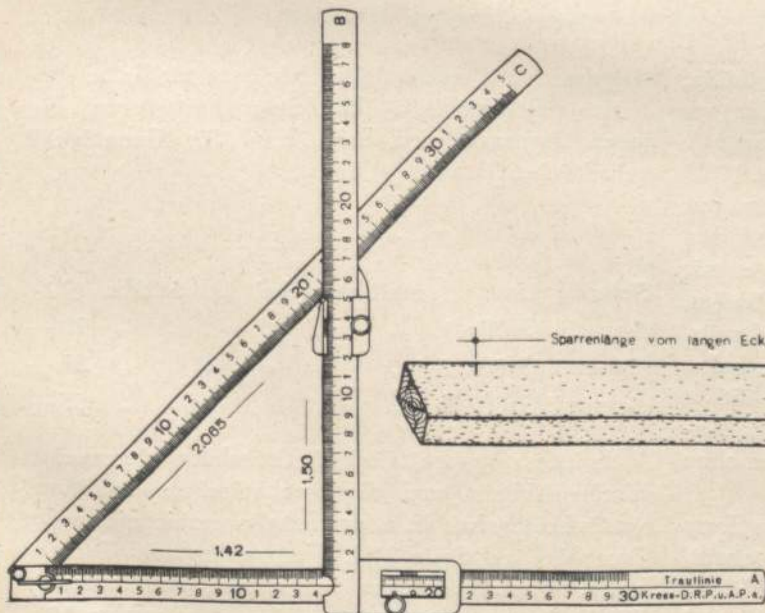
Der Apparat (Größe 1) ist auf das Hauptdachprofil des Walmdaches in Abb. 1102 eingestellt.
